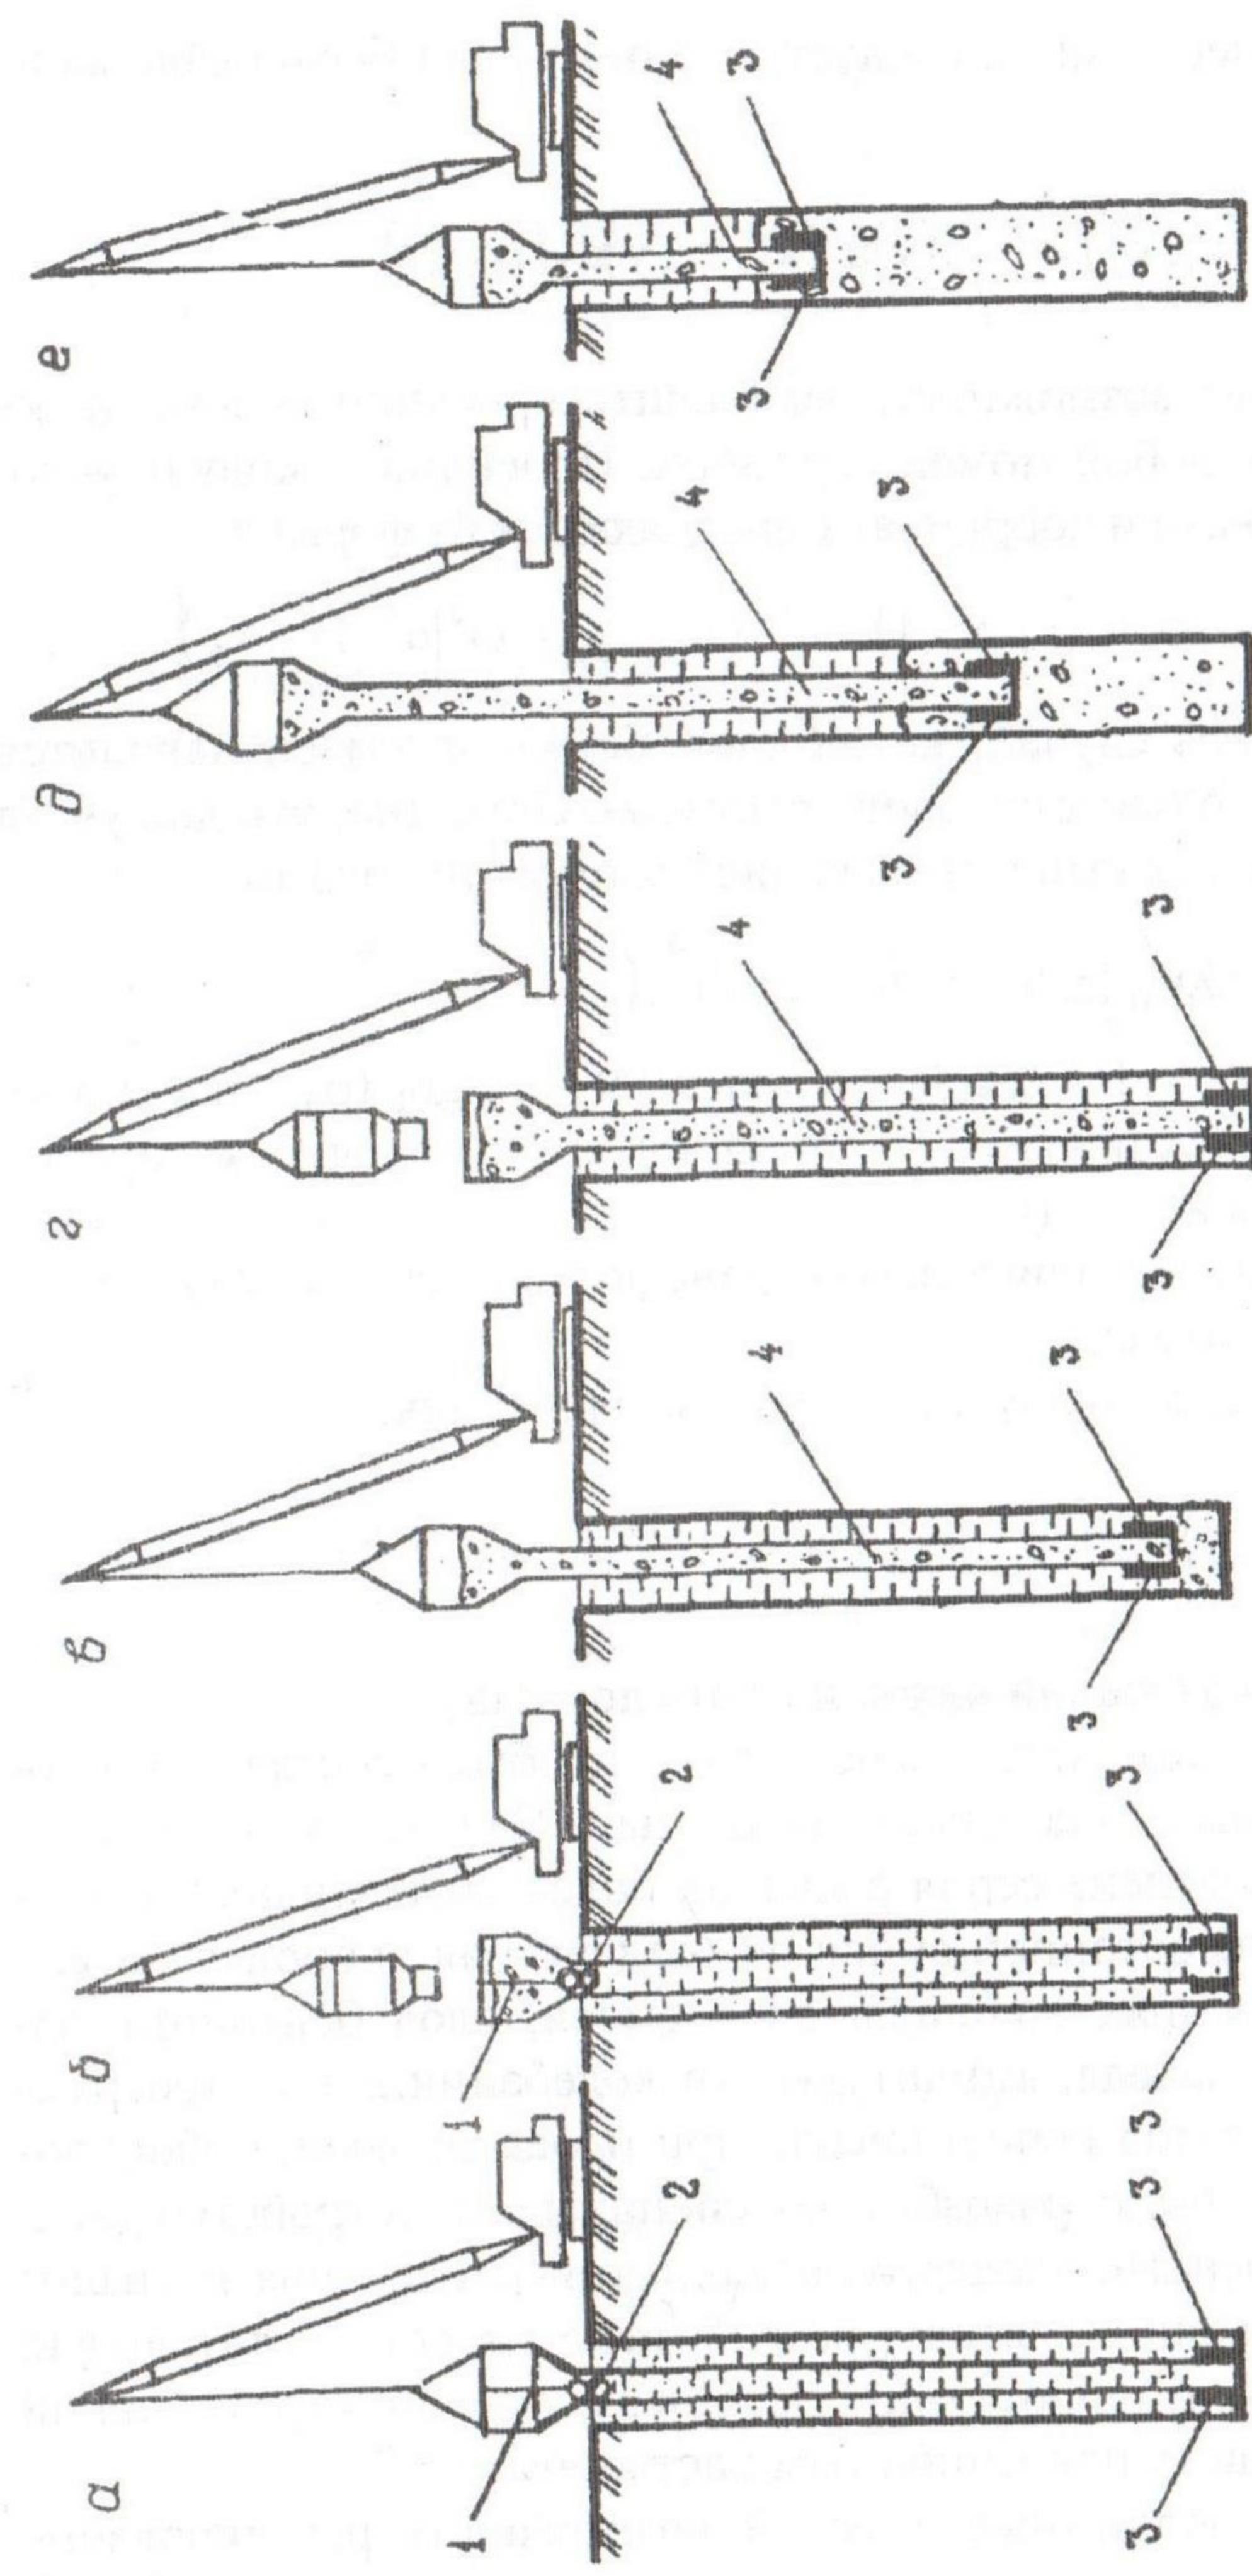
Вибронагнетательной технологии бетонирования стен в грунте
